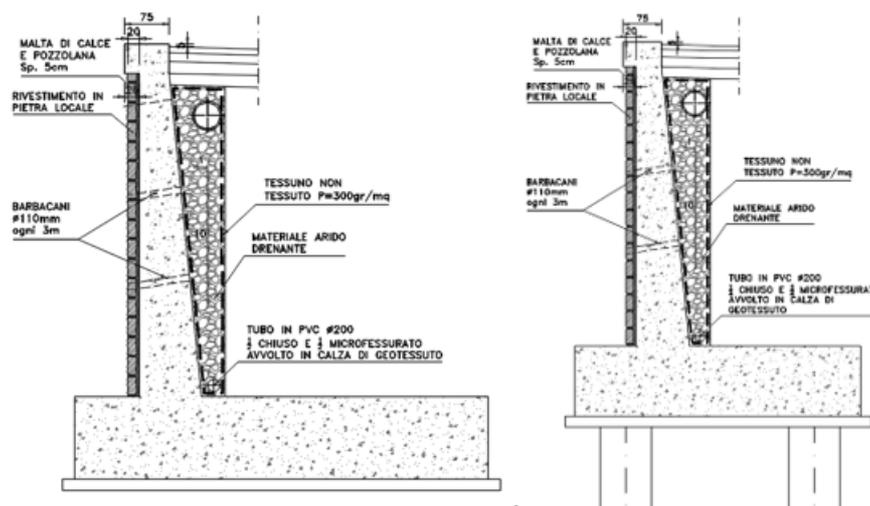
Sezione tipo muro di sostegno su fondazione diretta (a sx) e sezione tipo muro di sostegno su pali (a dx)
